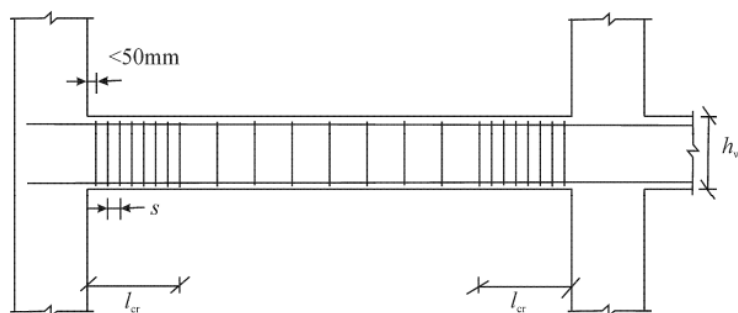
Armaduras transversais em secções críticas da viga (IPQ, 2010)
